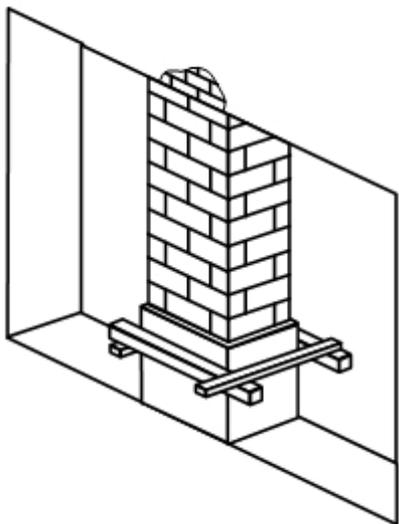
Устройство опалубки при усилении кирпичного простенка железобетонной обоймой
